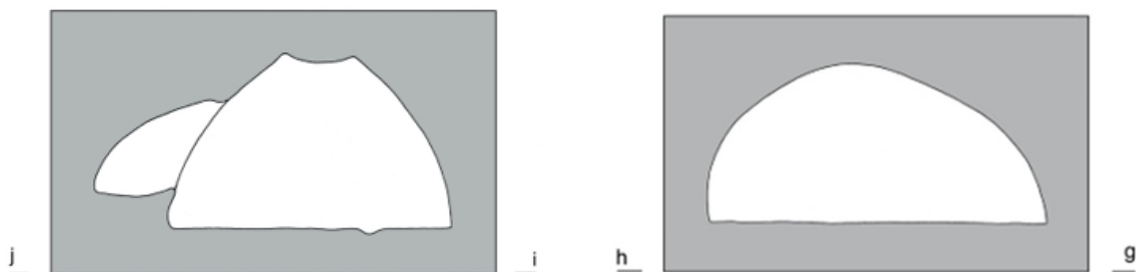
Sección transversal de la cubierta abovedada del sepulcro 11 (izquierda) y 9 (derecha)
